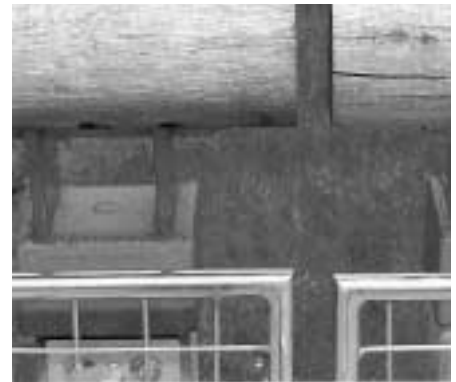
Handlauf aus Rundholz, beim Stoß mit Abstand ausgebildet
